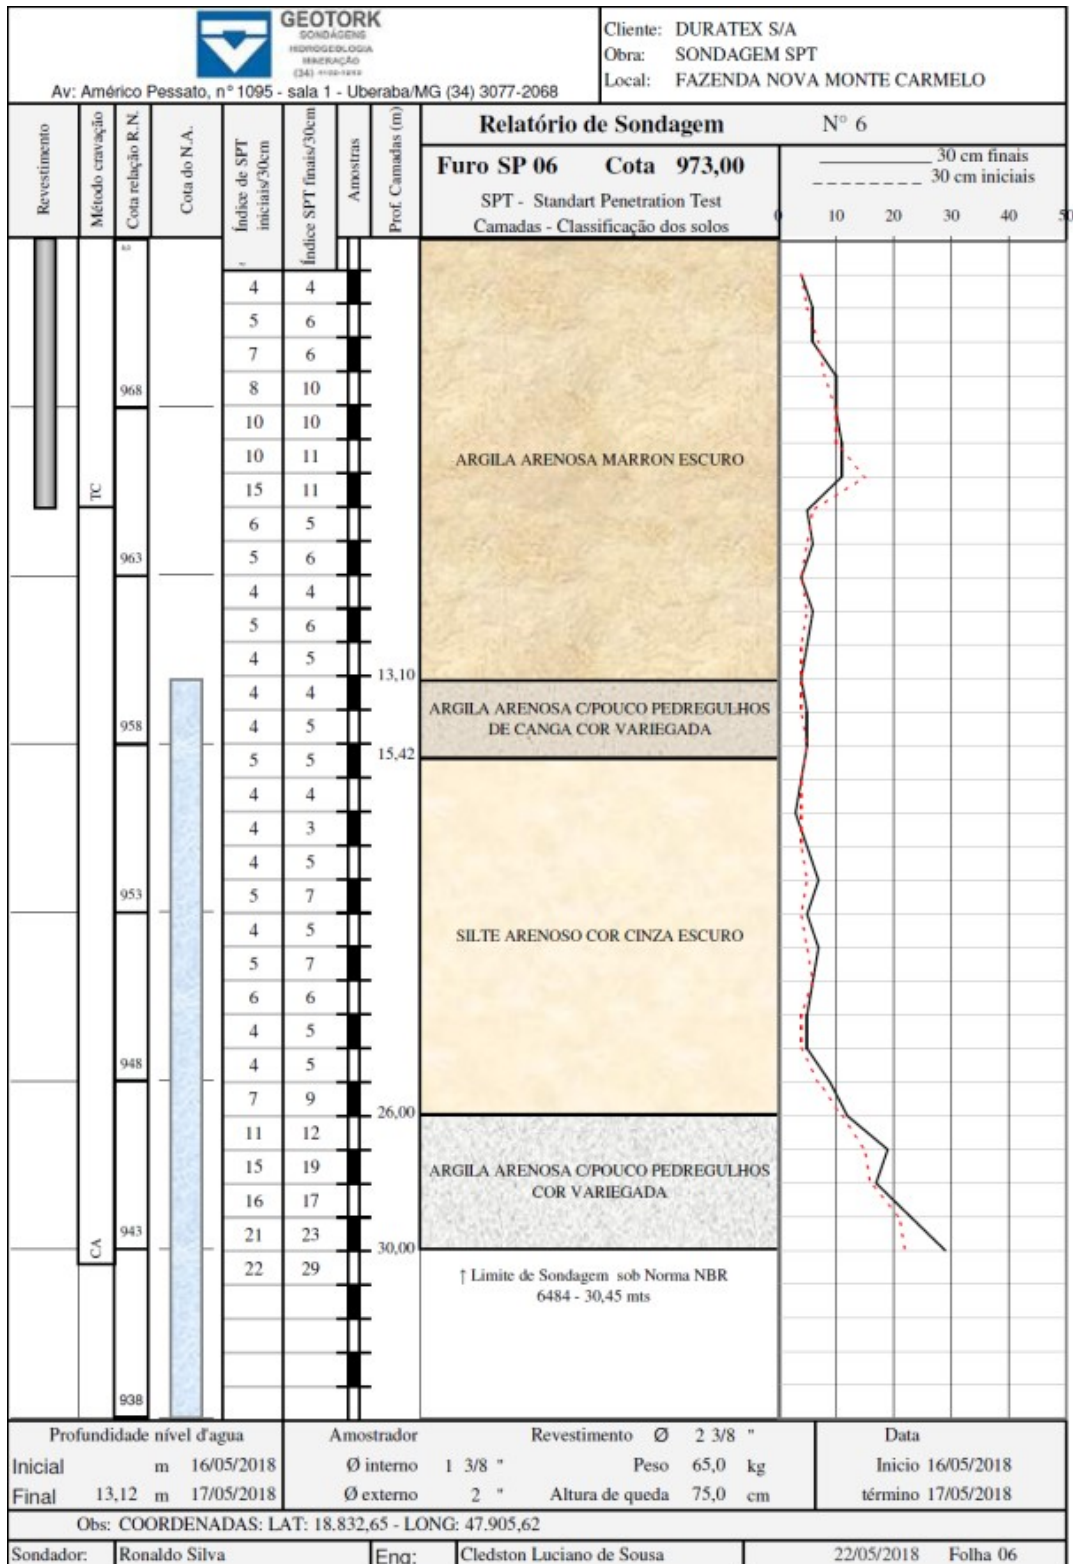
Perfil do furo de sondagem SP06. Fonte: GEOTORK, 2018.
